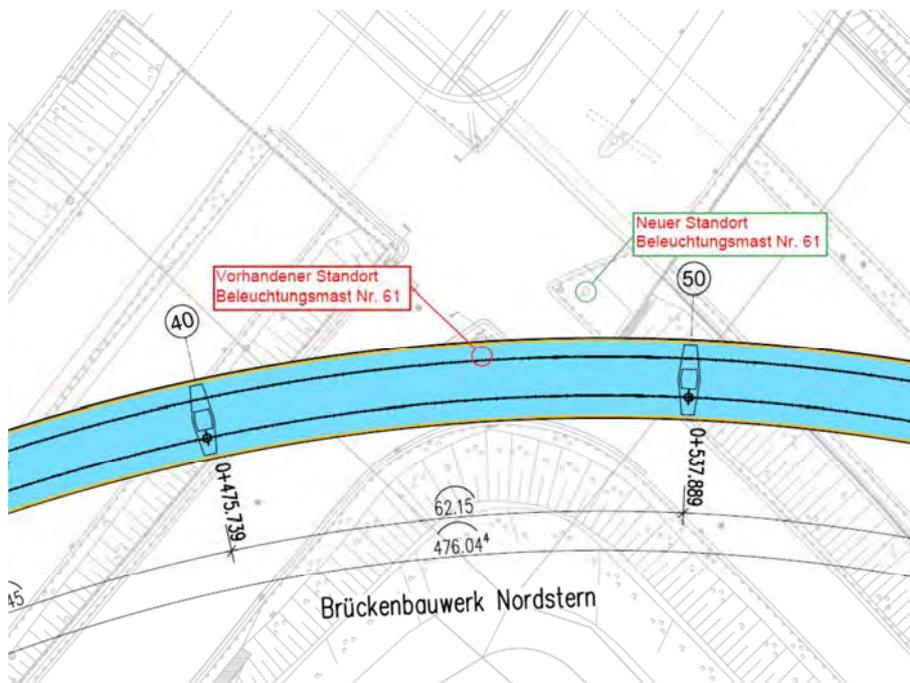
Grundriss versetzter Beleuchtungsmast Nr. 61
